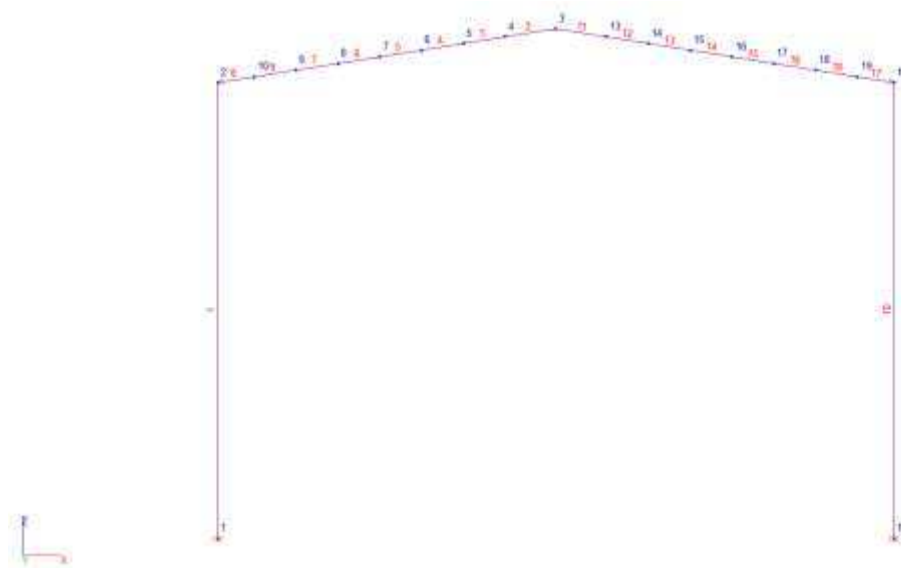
Расчётная схема поперечной рамы здания в осях 2/Б-В (каркас)
